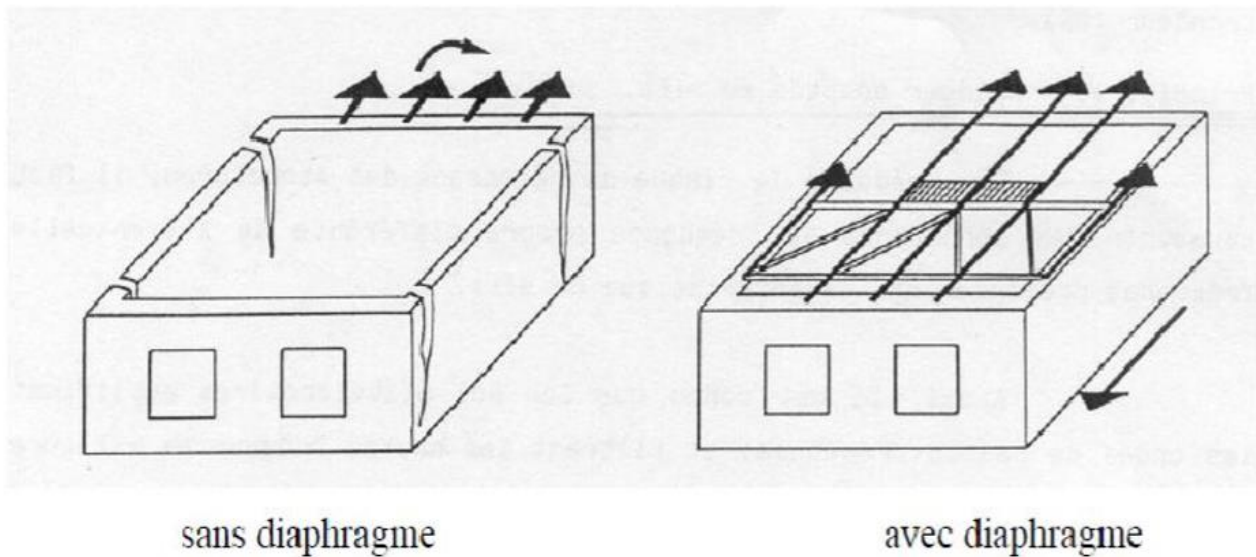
Effet d'un séisme sur une construction en maçonnerie sans (à g.) et avec (à dr.)
